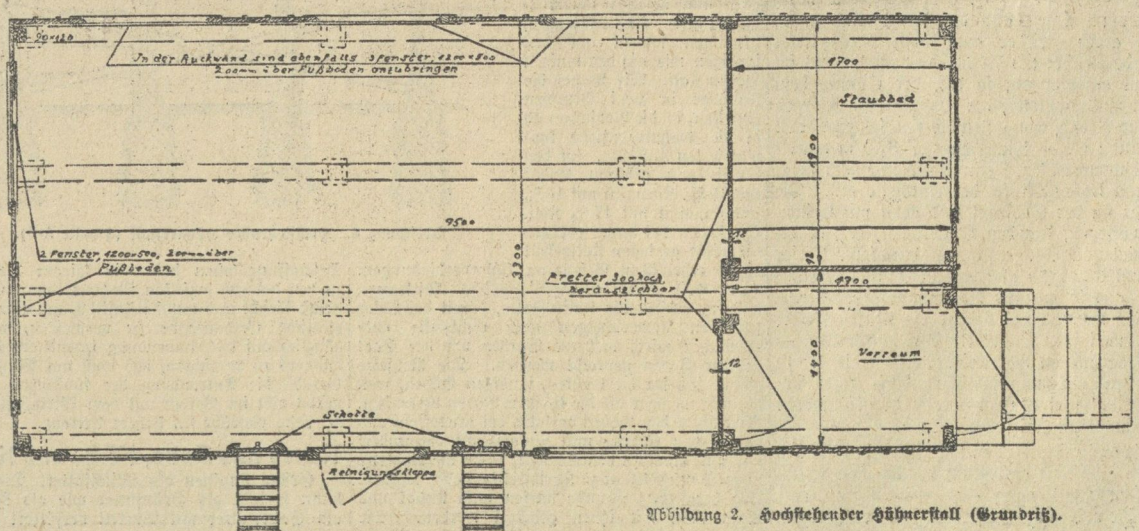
Hochstehender Hühnerstall (Grundriß).
